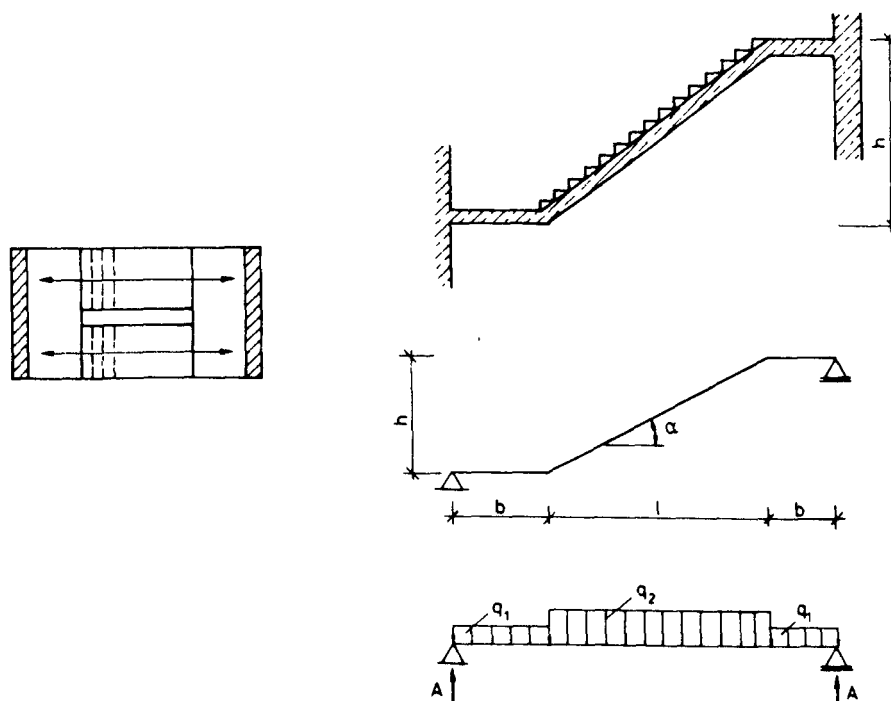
An den Enden gelagerte Treppe, Grundriß, Schnitt, statisches System
